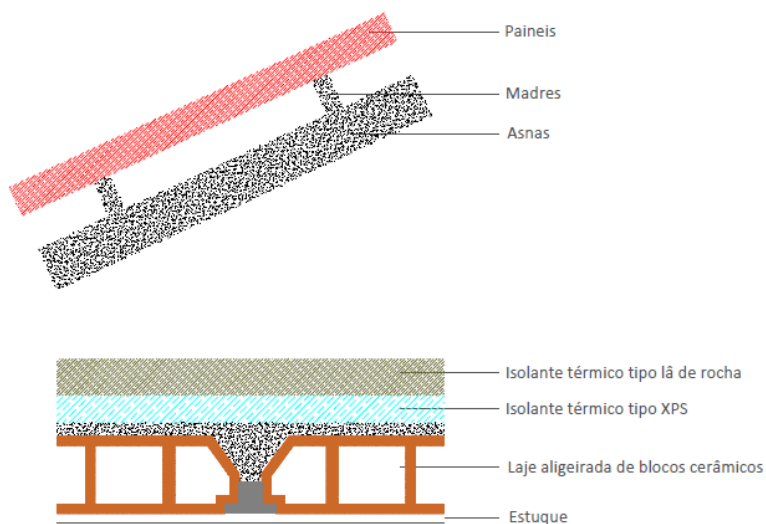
Solução construtiva tipo de pavimento para desvão sob cobertura – Pós intervenção
